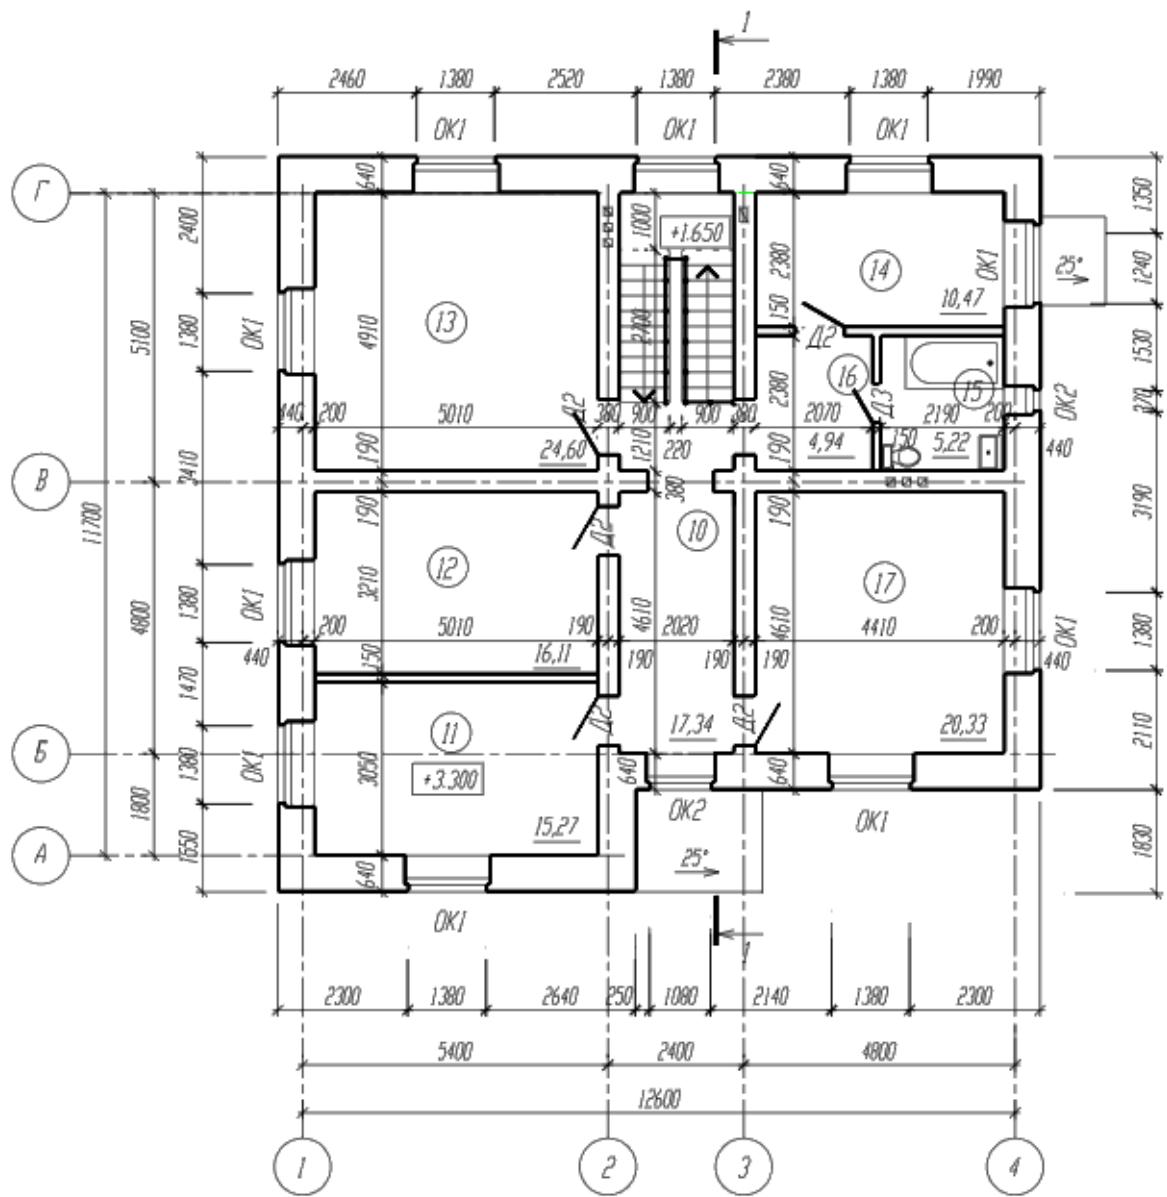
Пример оформления плана 2-го этажа жилого дома, со стенами из мелкоштучных материалов.
